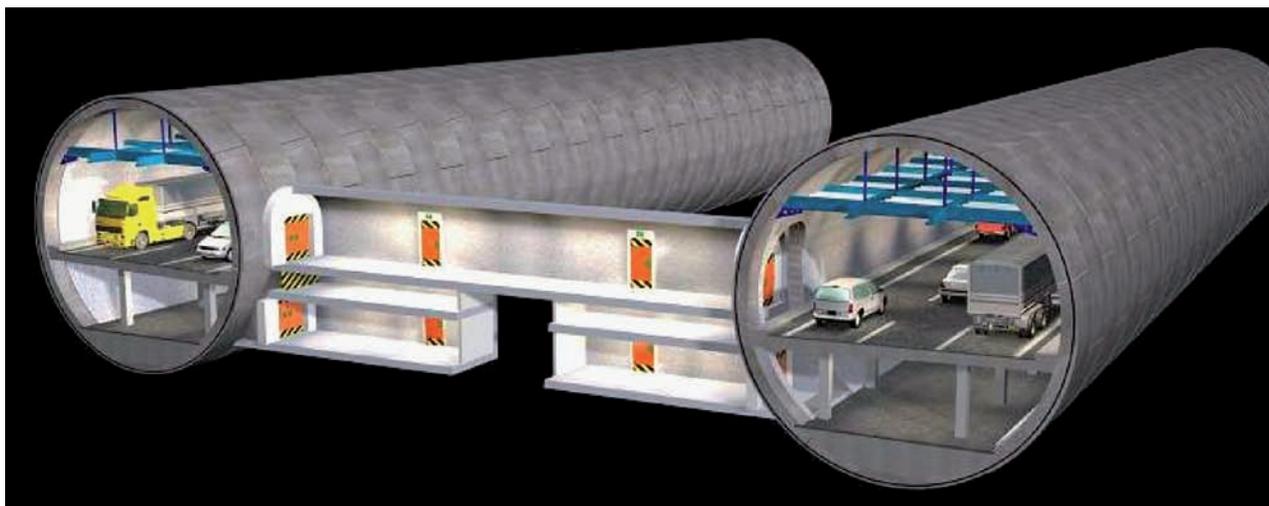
Sección Tipo de los Túneles de Calle 30 (Madrid).
